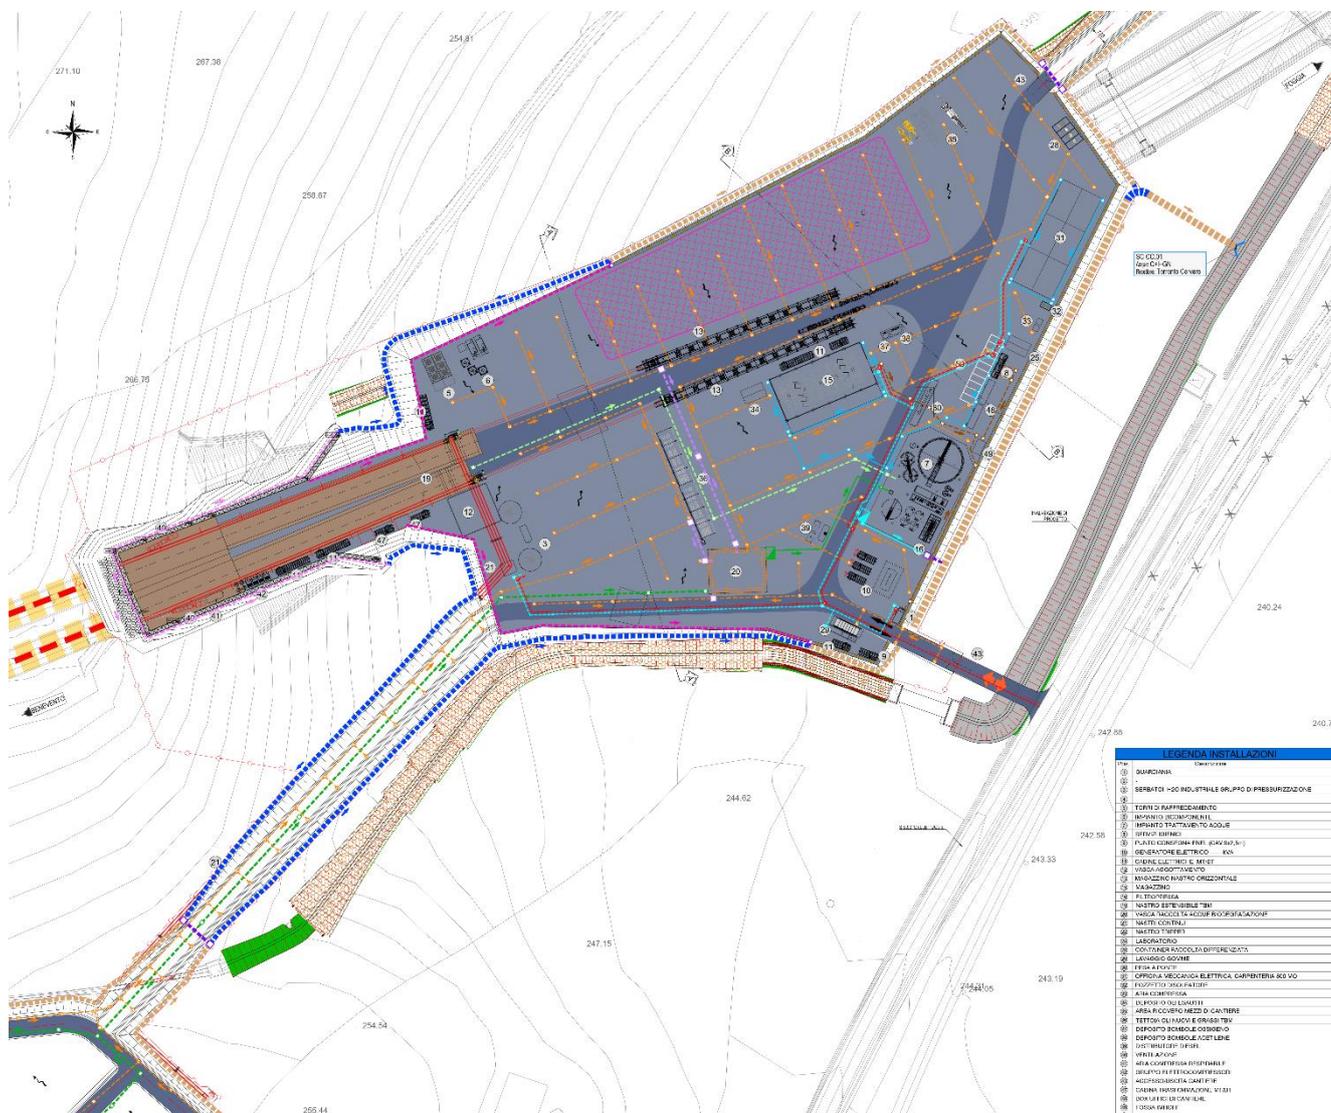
Planimetria complessiva del cantiere G101- CO.01
